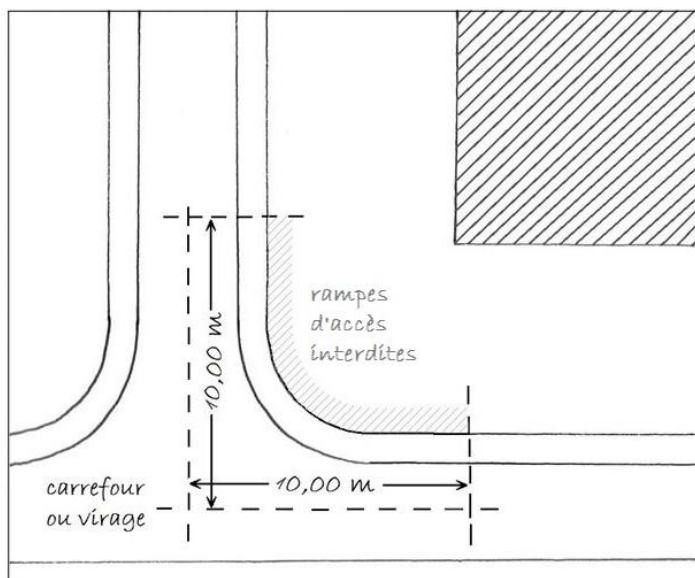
Rampes d'accès à proximité d'un carrefour ou d'un virage
